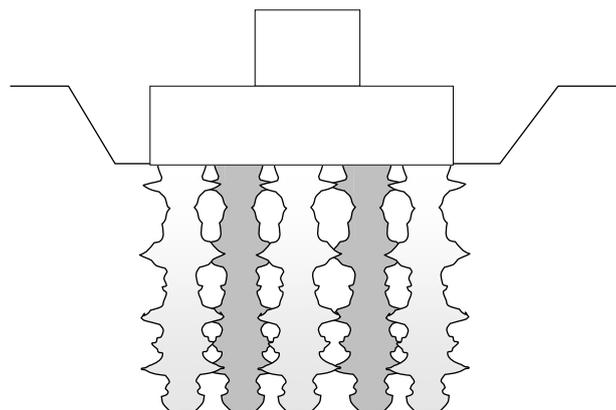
a Croquis de cimentación de zapata con columnas de jet - Sección
